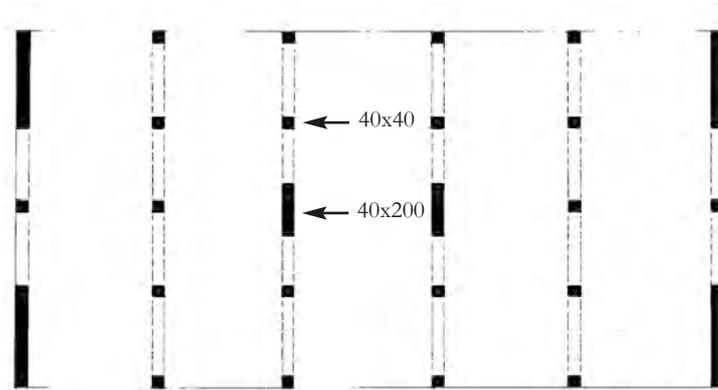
Poteaux non superposés (à éviter). Les tronçons courts de la poutre ainsi que la poutre courte pourraient subir une rupture fragile.
